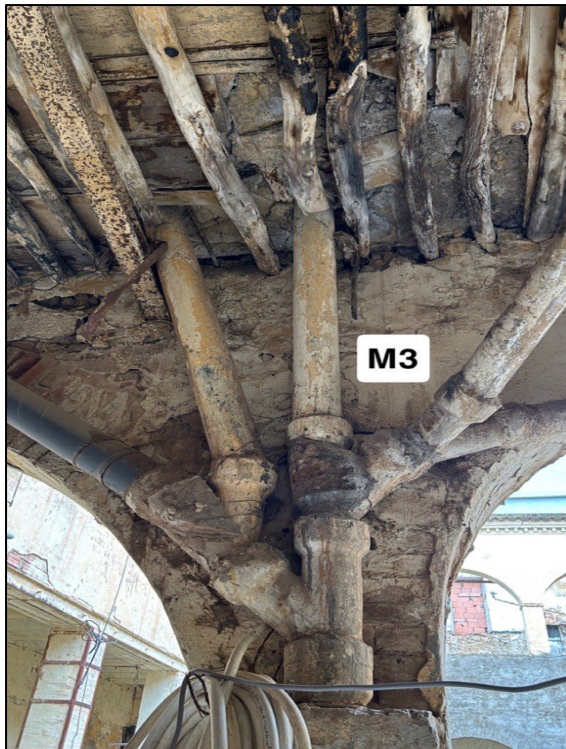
Dégradation liée à l'humidité au niveau d'un mur en pierre traversé par un réseau d'assainissement
